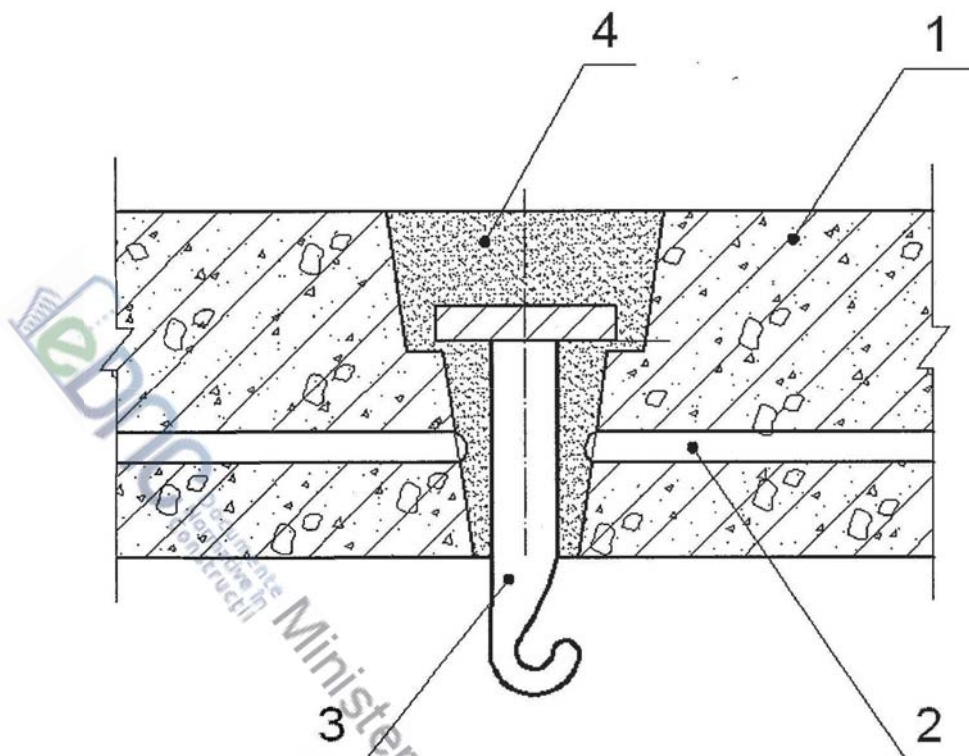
schema soluției constructive de scoatere a conductorului din planșeu spre plafon (planșeu cu gaura străpunsă)
